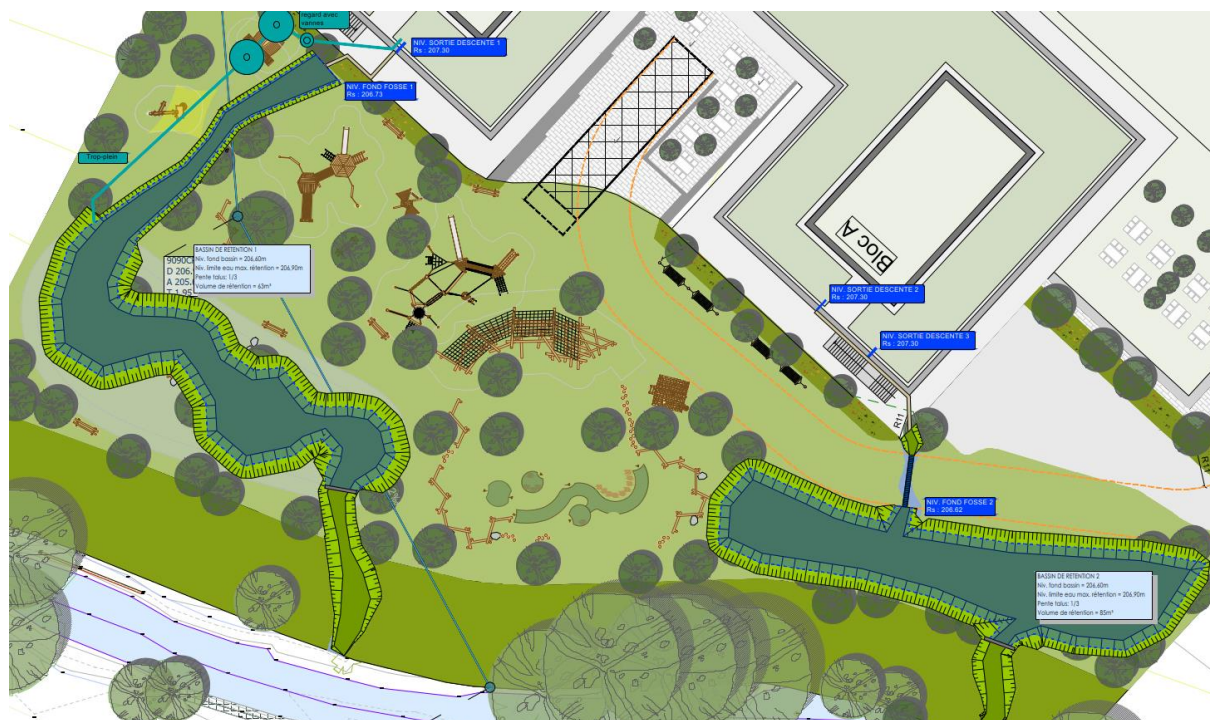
Geplante oberirdische Retentionsbecken im Südwesten der Planzone (Quelle: LUXPLAN S.A. 2023).
